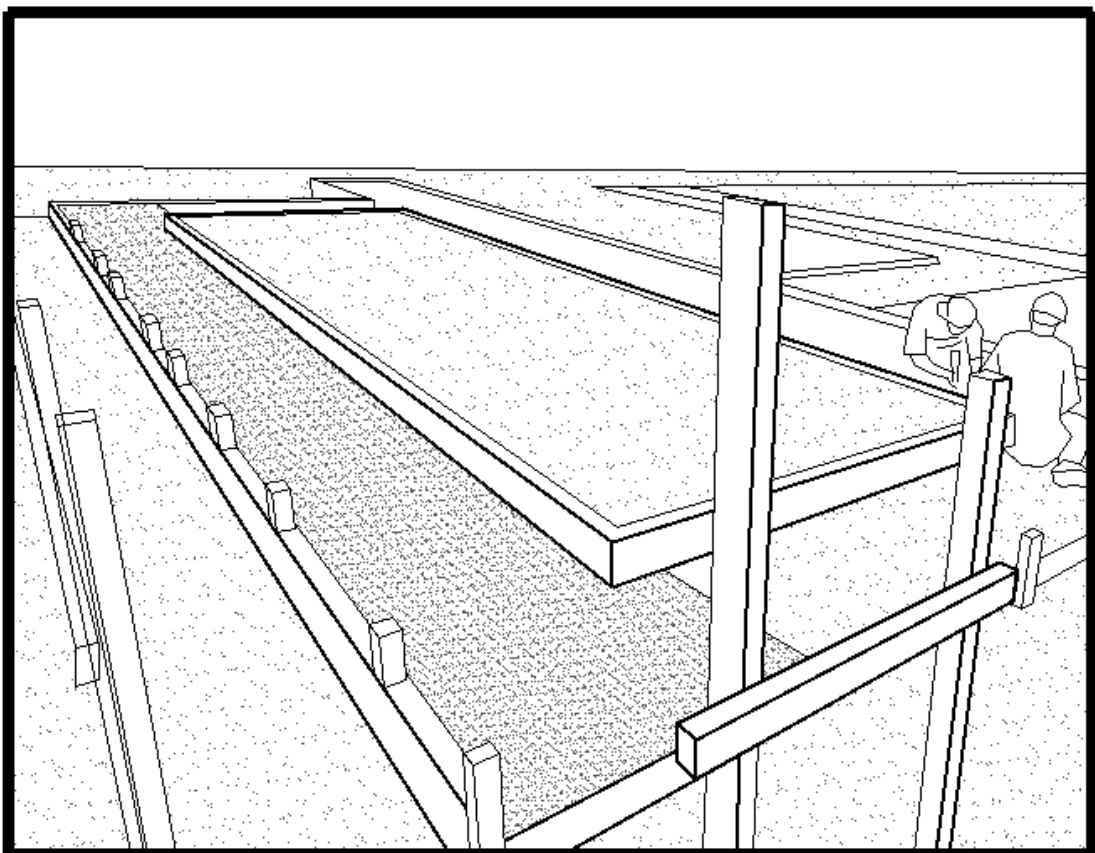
Colocación del concreto como contra piso para plantilla de hilada de bloque, inicio de albañilería.
